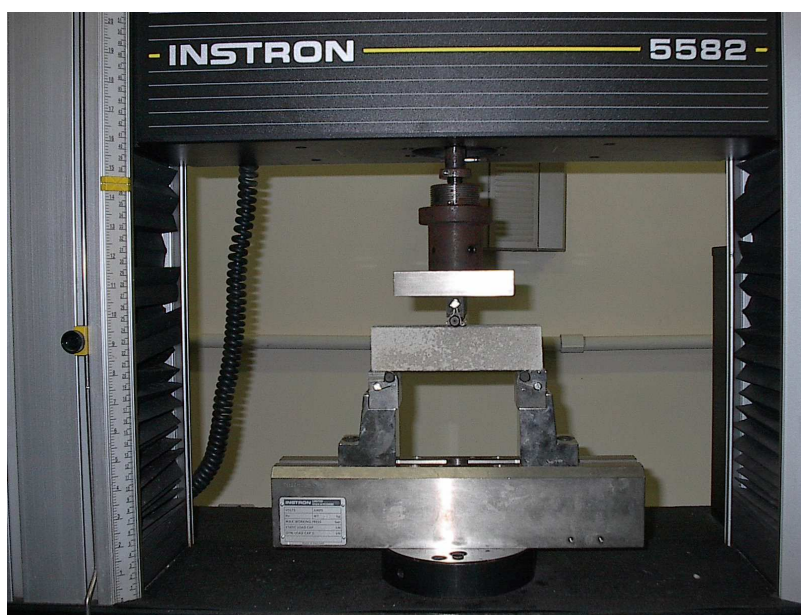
Realização do ensaio de tração na flexão na prensa INSTRON.
